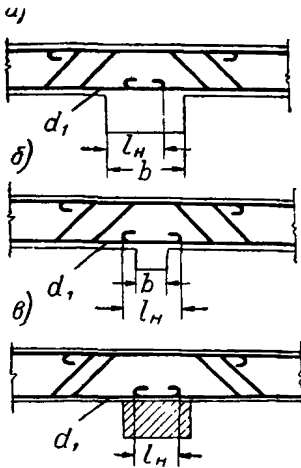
Стыки нижней продольной арматуры на опорах неразрезных второстепенных балок при необходимости учета сжатой арматуры в опорных сечениях (в случае применения для продольной арматуры стали периодического профиля на концах стержней крюки не устраивают)
